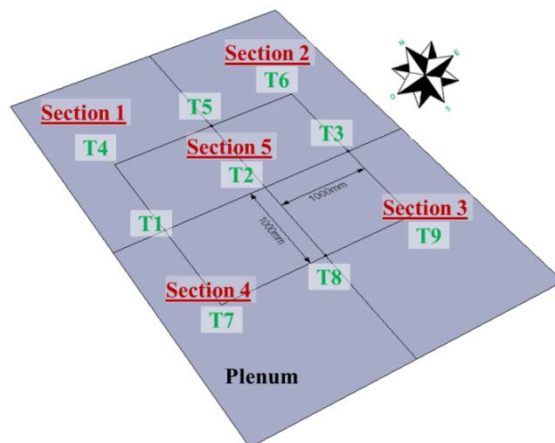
Position des sections et des thermocouples dans le plenum du plancher
